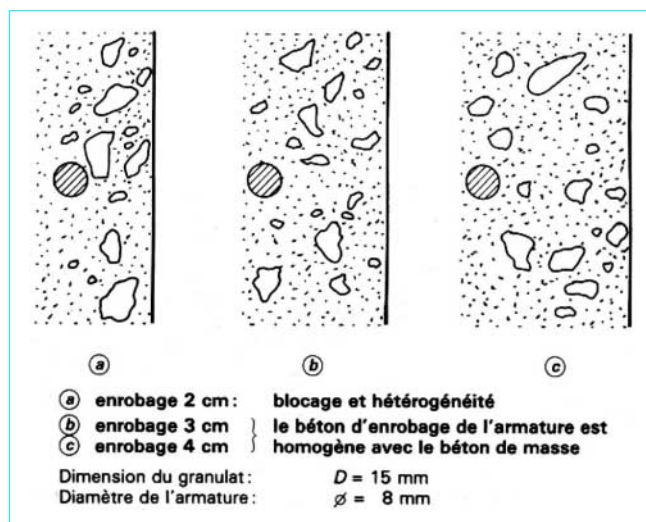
Relevés de coupes de béton effectuées au droit d'une armature horizontale le long d'un coffrage vertical
